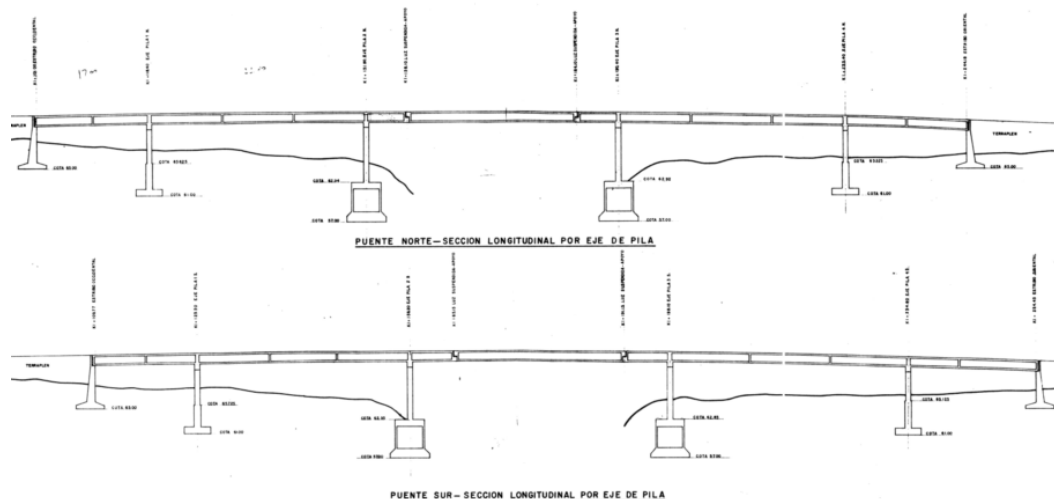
Secciones longitudinales del puente norte y sur, respectivamente
